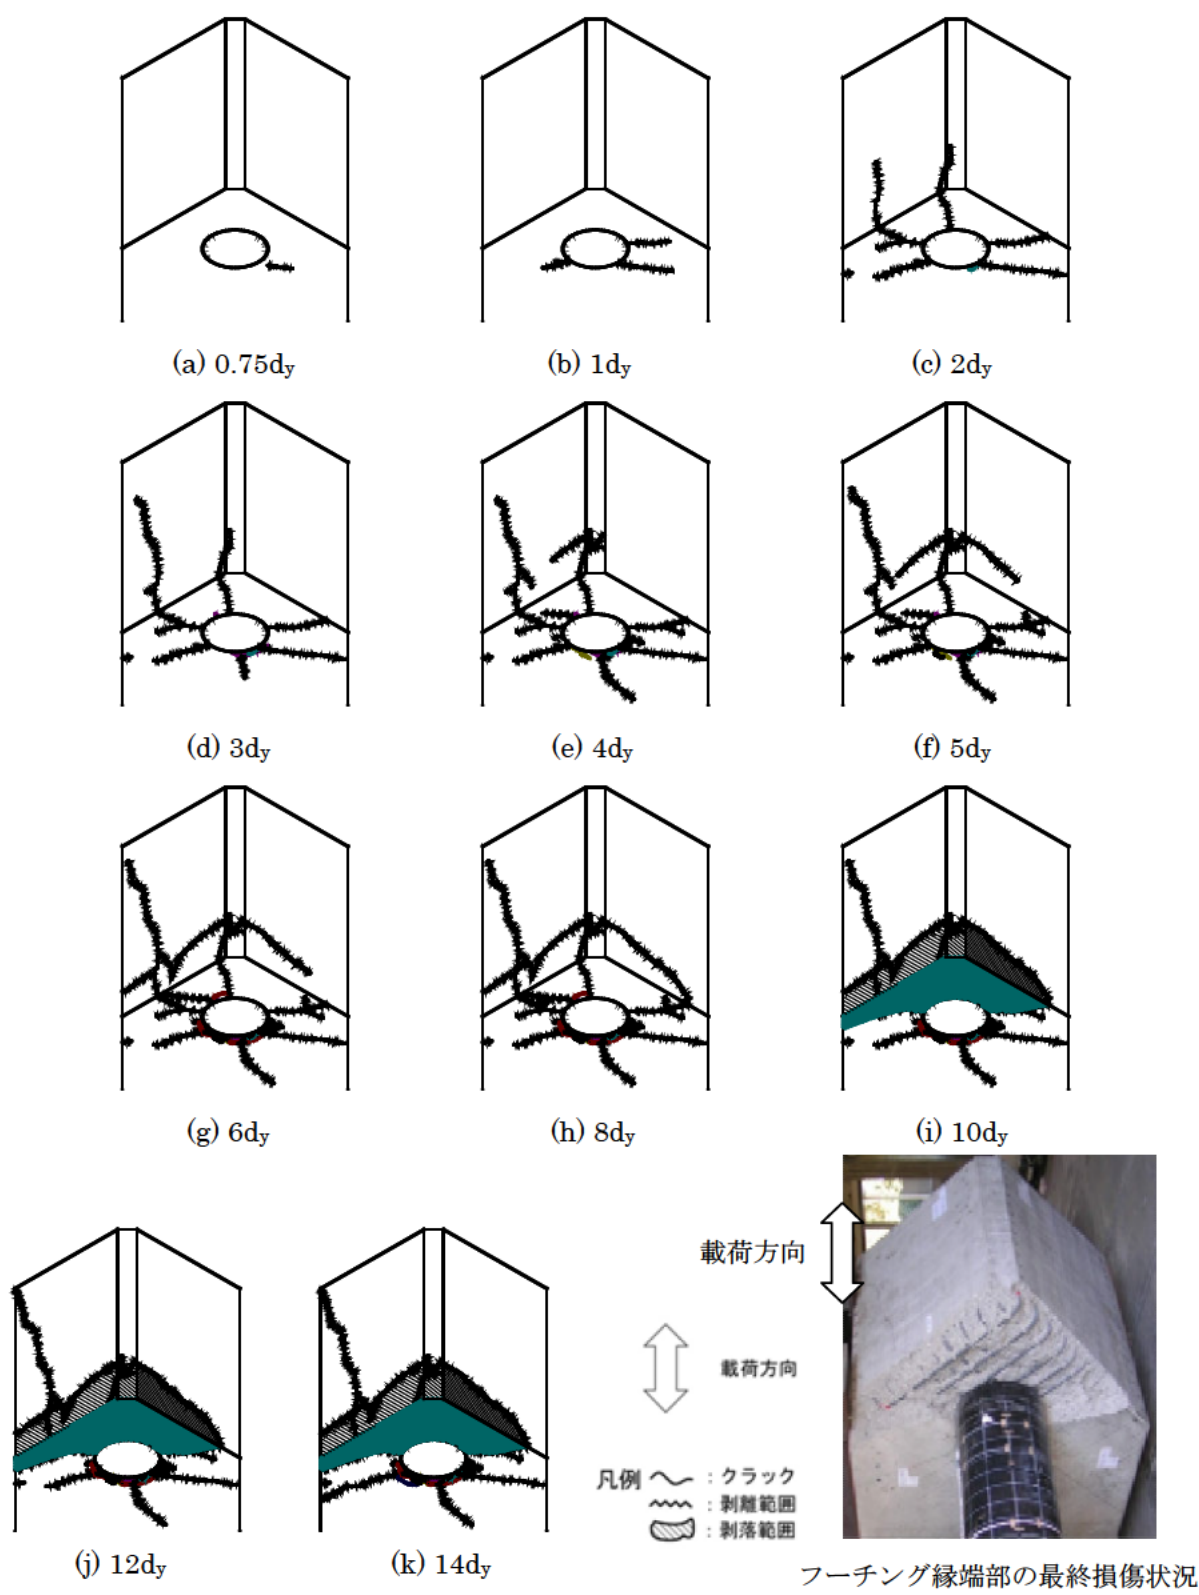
フーチング下面のひび割れ進行状況図 (Case SPP-C-2, PileB)
